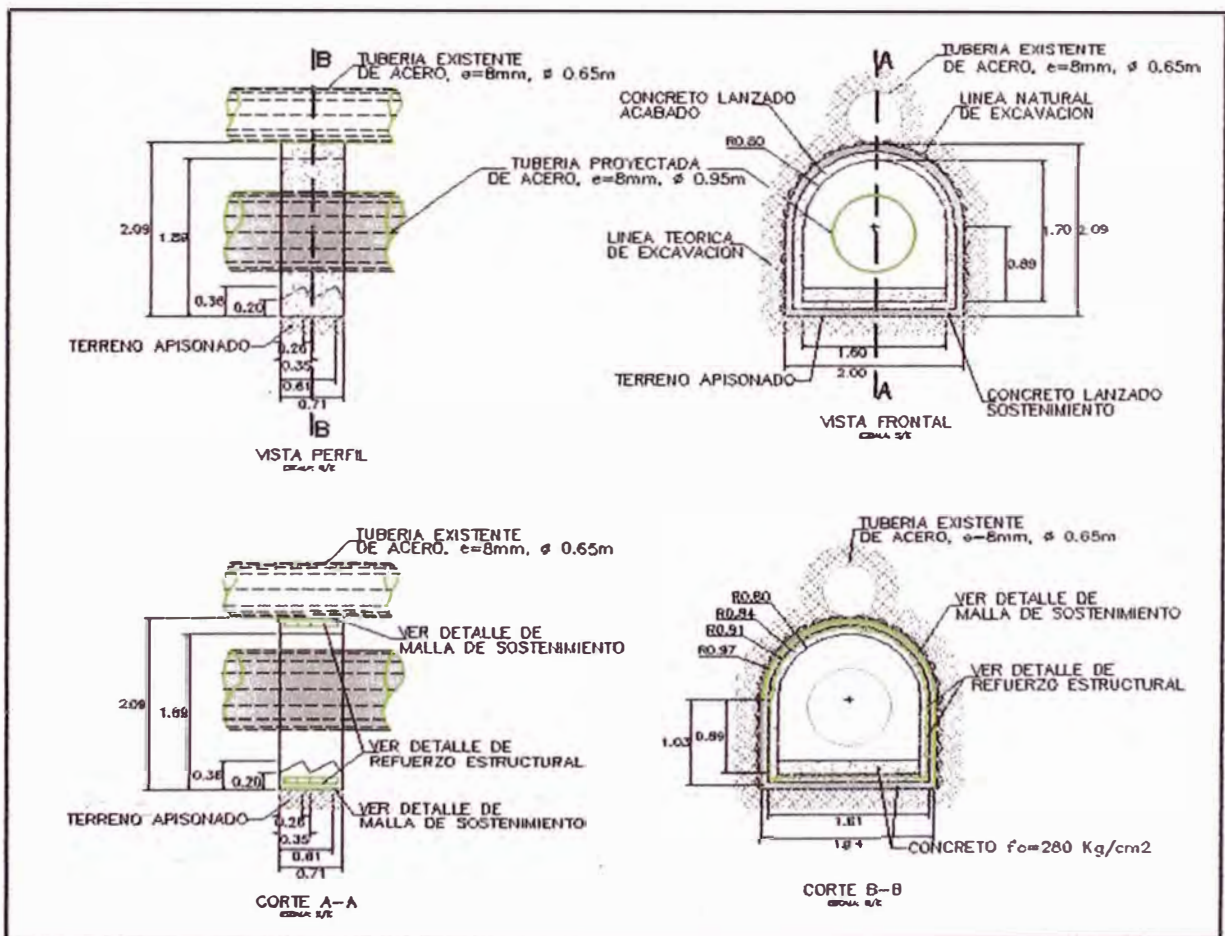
Detalle módulo de túnel (concreto lanzado)
